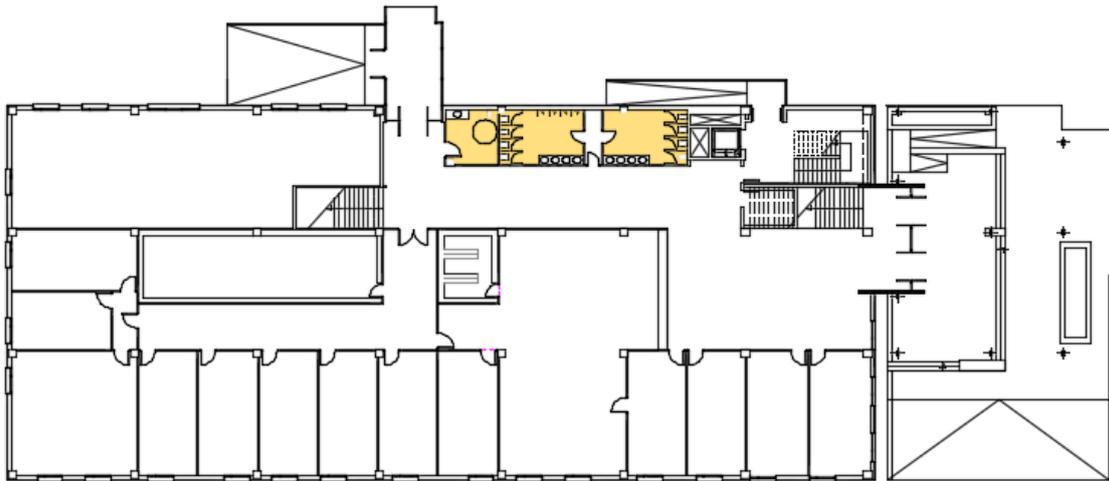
Situación Aseos en Planta Baja. Figura extraída del plano 52.
